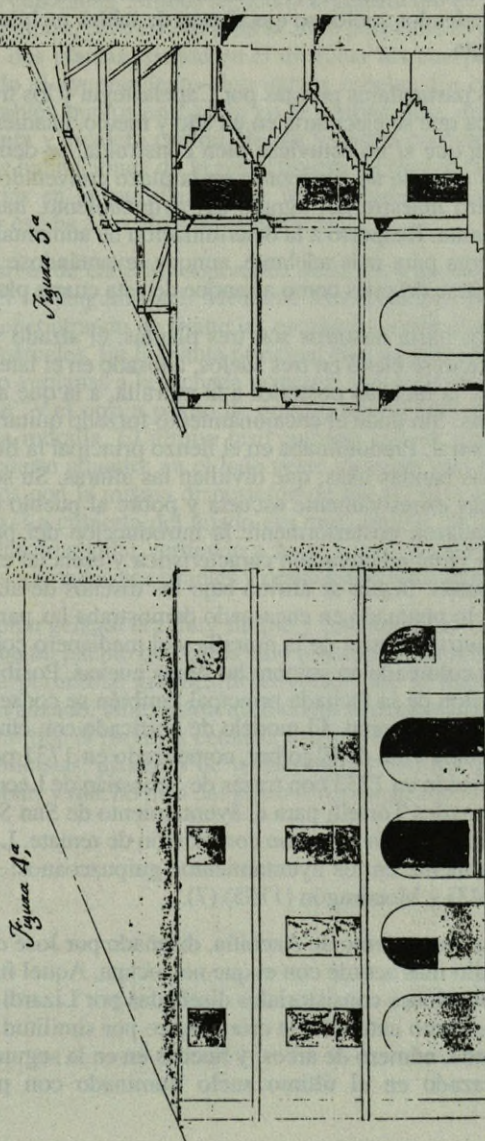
^a, alzado de la fachada principal. Figura 5.^a, perfil de Lamius.
